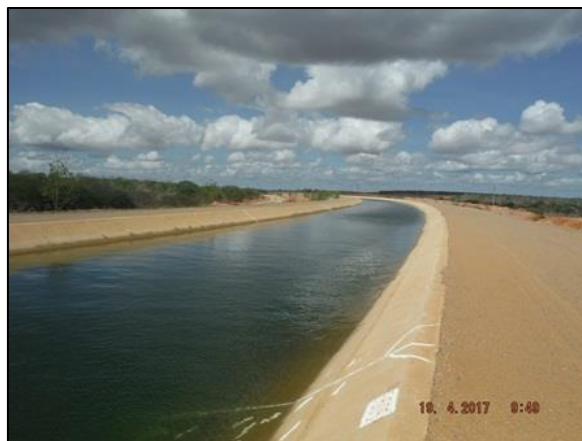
A estrutura para passagem da fauna não foi construída no local.
